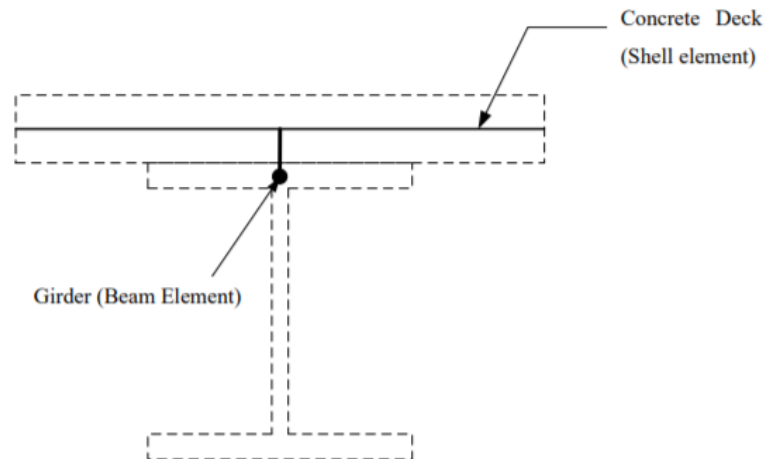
Modelo tridimensional via MEF (Modelo de viga excêntrica). Fonte: Adaptado de Bapat (2009)
